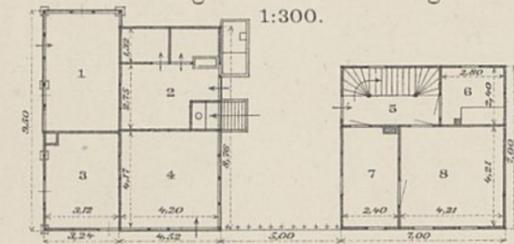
u. 6. Grundrisse des Erdgeschosses.
